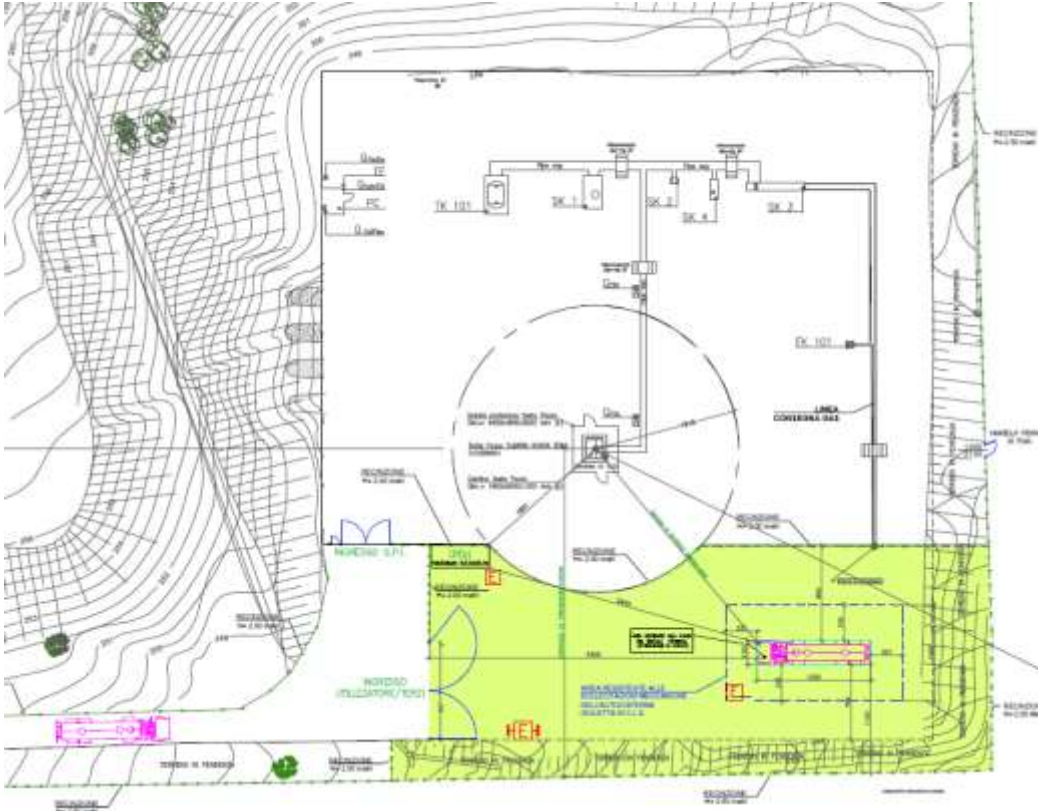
estratto planimetrico della Planimetria generale dell'area pozzo S. Maria Nuova 3 DirA
